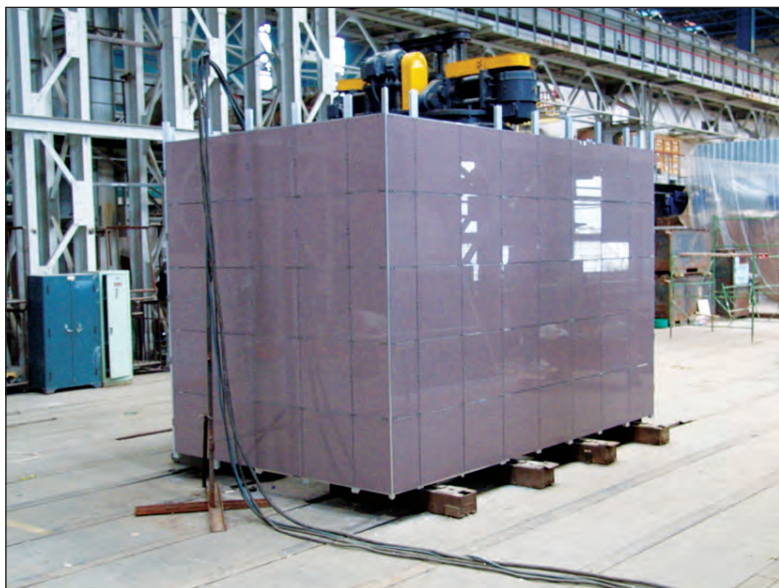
Общий вид испытательного стенда с конструкциями ФС «MAVent»
